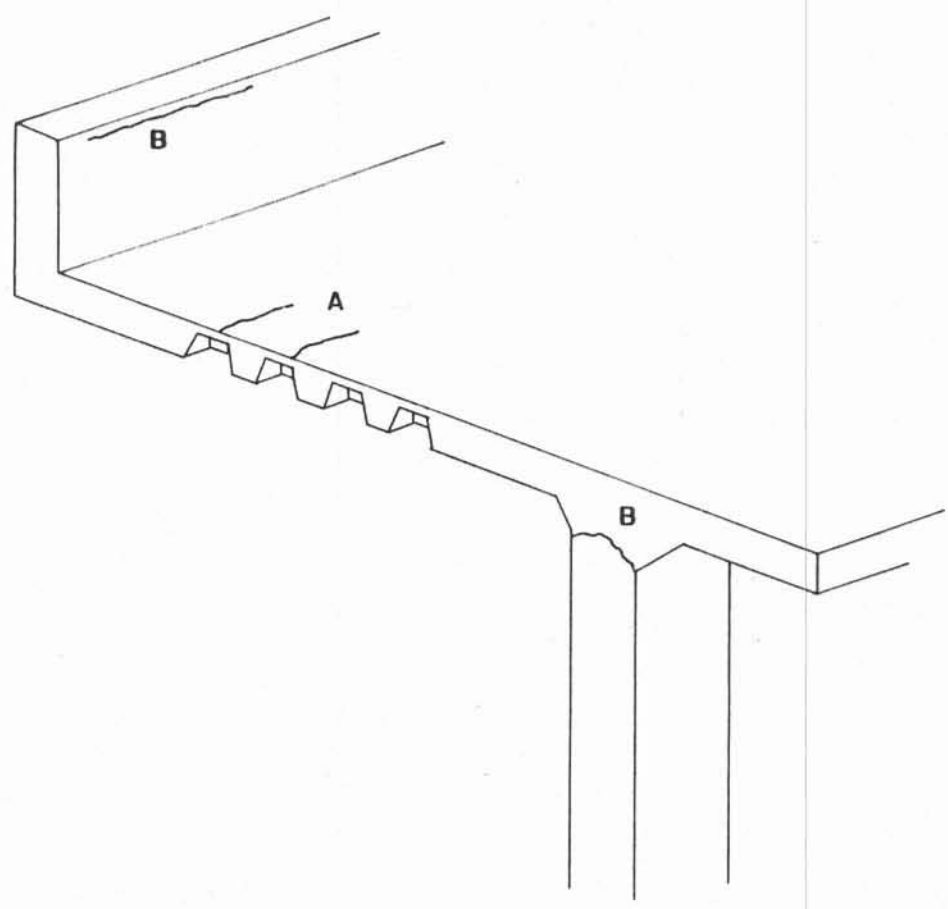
Configurações típicas de fissuras por assentamento plástico (CEB<sup>2,3</sup>)
